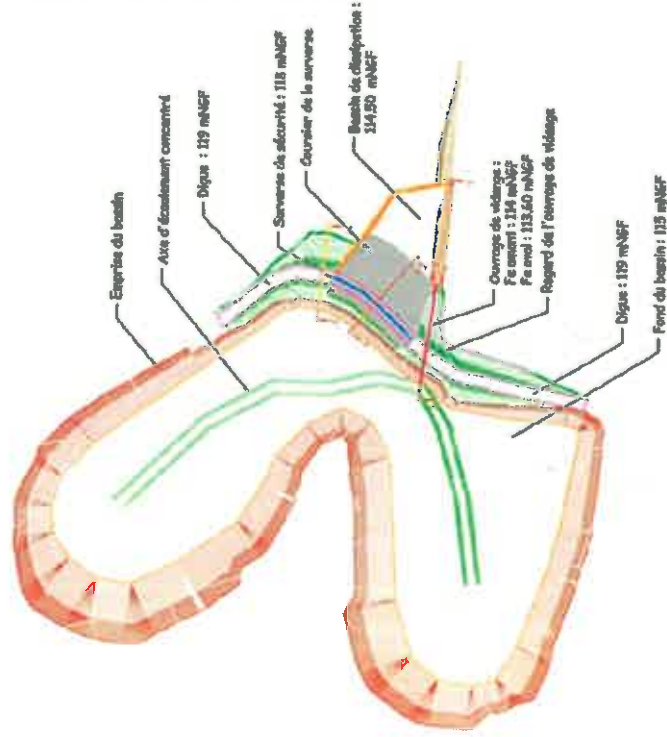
PLAN DU BASSIN D'ECRETEMENT DE COMBEMOUISE
